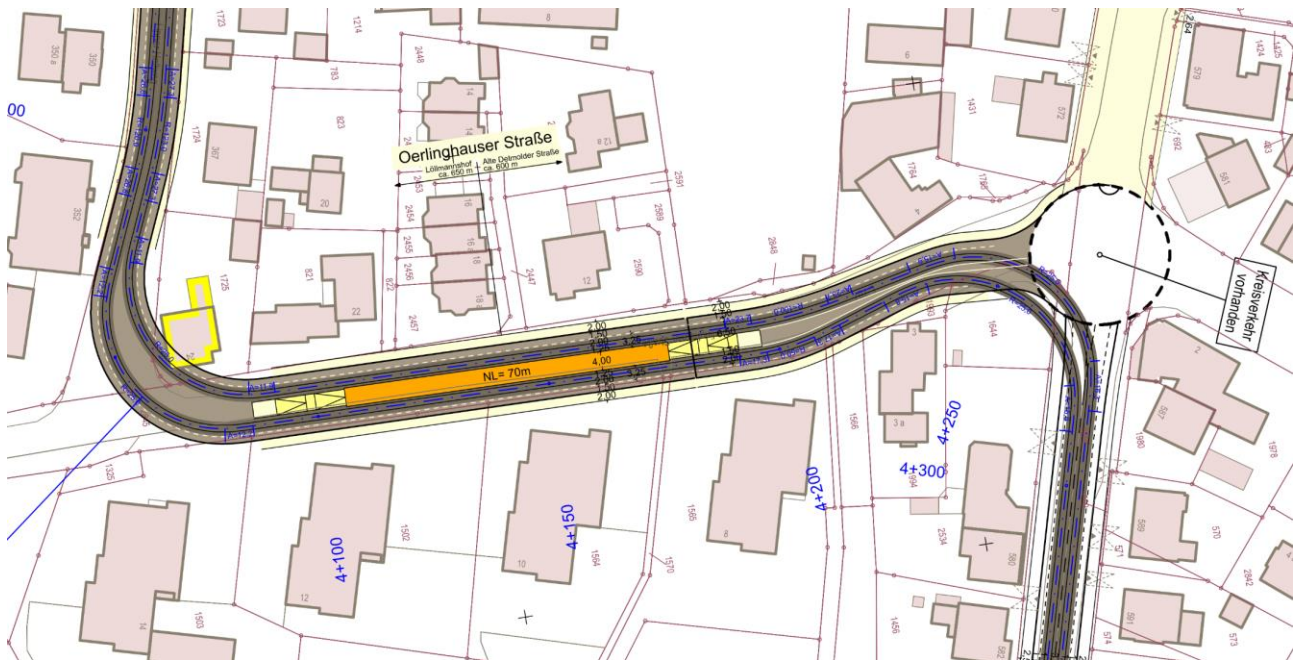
Lageplan Trassenvariante 8 Haltestelle Löllmanshof
